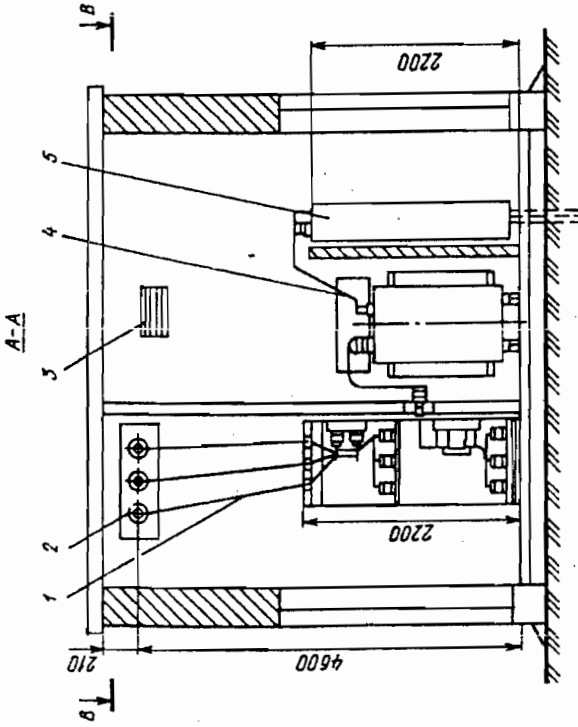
Габаритные, установочные и присоединительные размеры подстанции ЗТПС-10-1Т2В:
